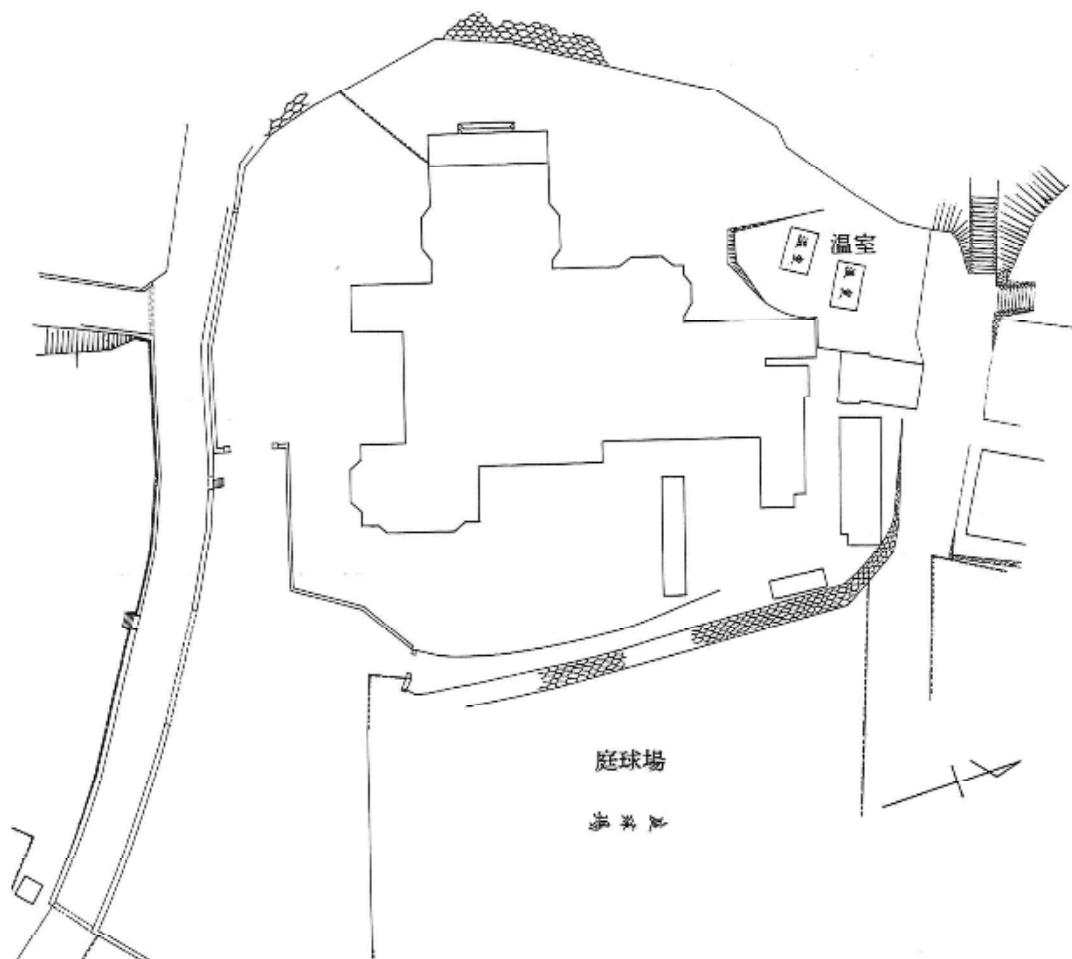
炭礦俱楽部配置図（山之上俱楽部平面図）
